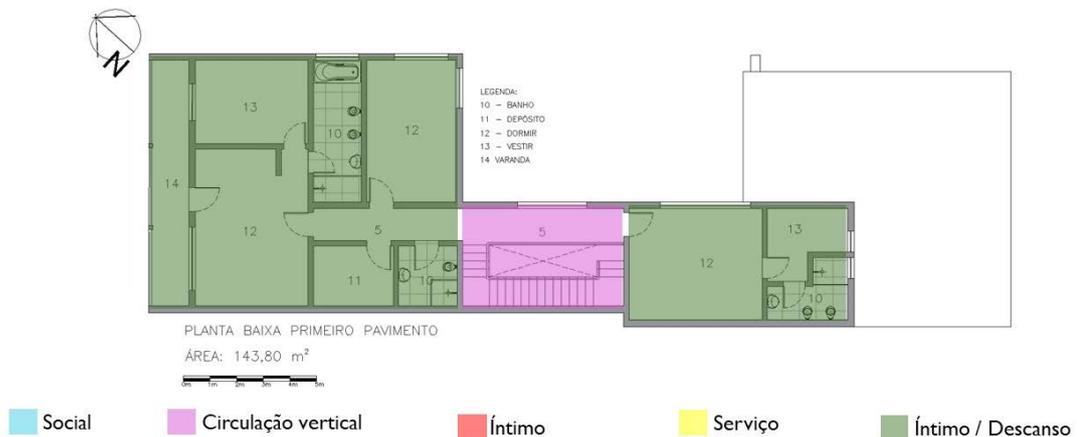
Planta Baixa do primeiro pavimento. Fonte: Elaborado pelo autor com base em levantamento do local (2018)
